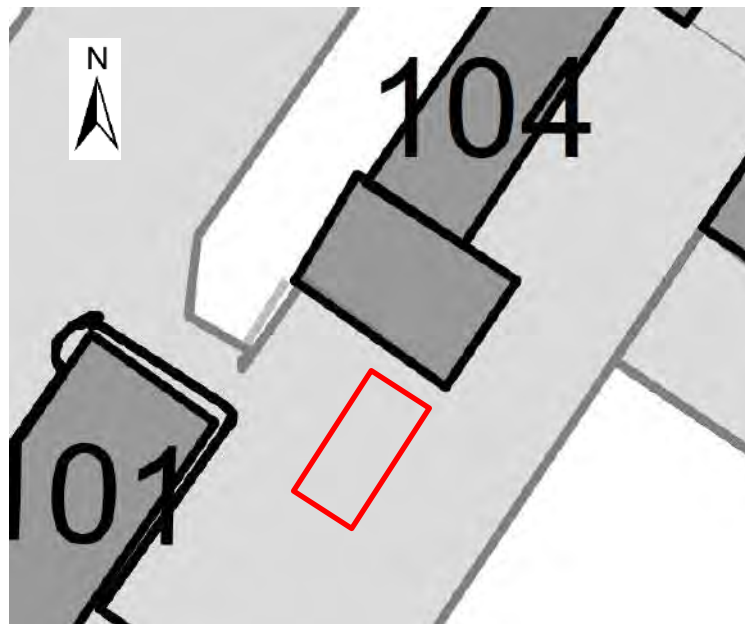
Detaillageplan des Waschplatzes (rotes Rechteck) vor Geb. 104. Ausschnitt aus [6]
